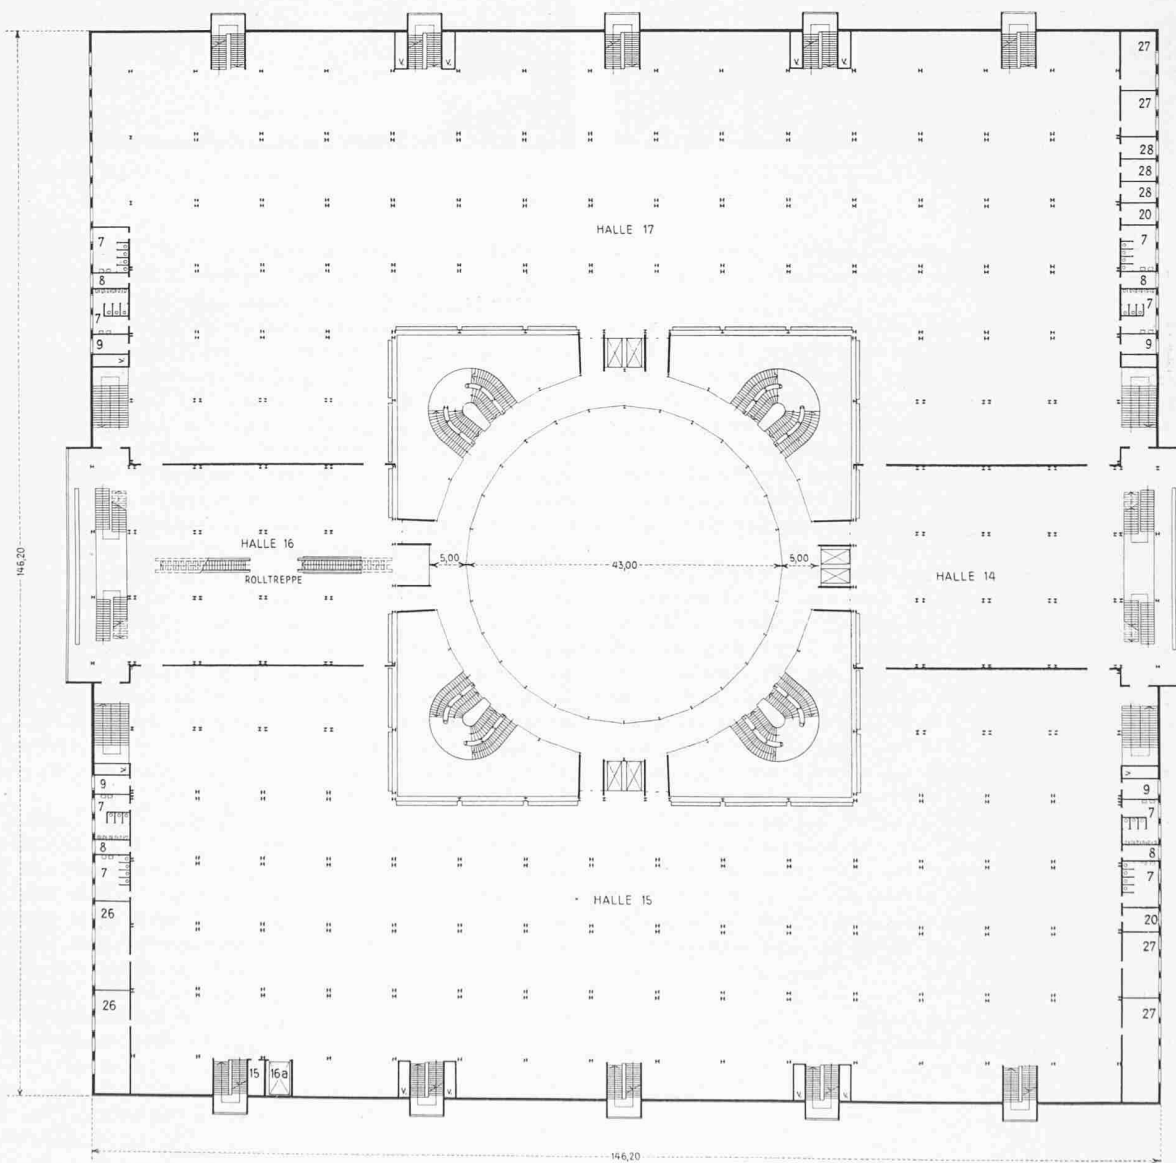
Obergeschossgrundriss, Masstab 1:1000
